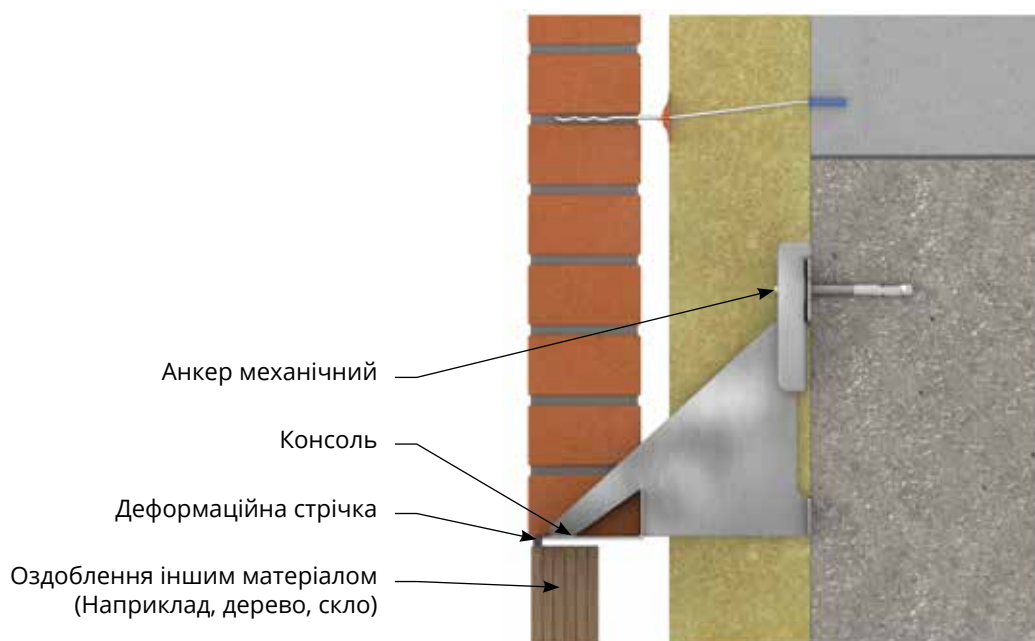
Зведення фасаду на висоті будівлі, версія 1
